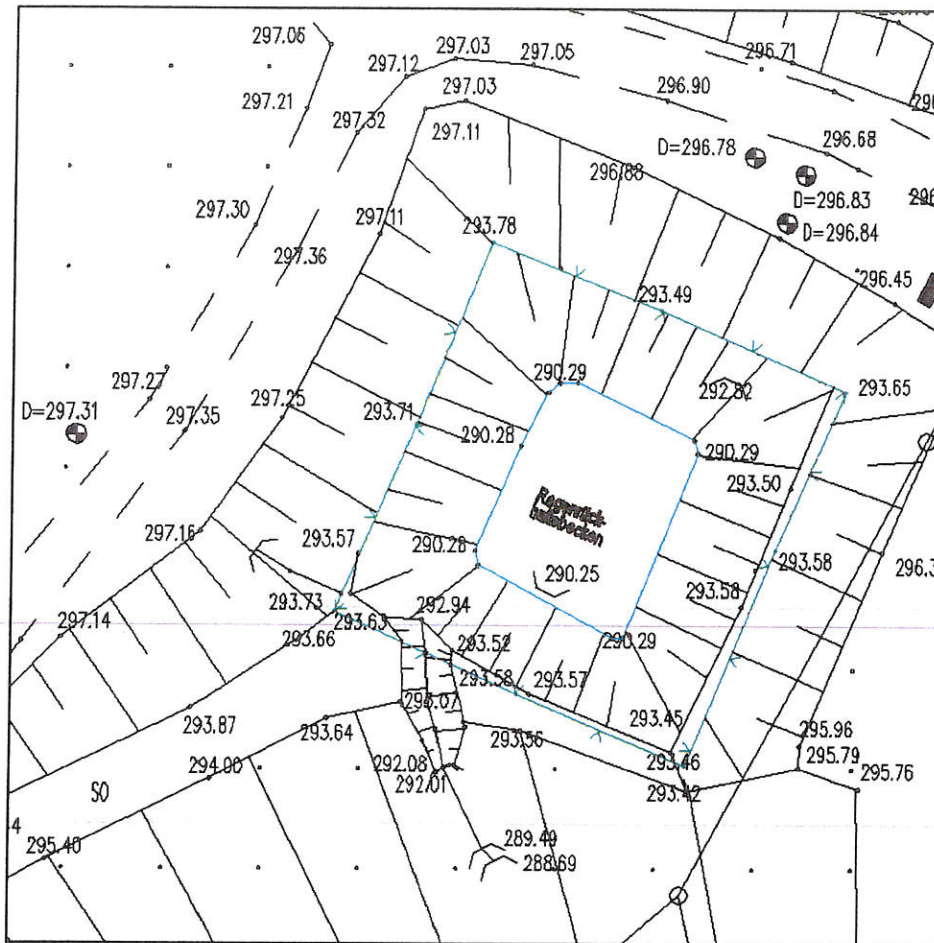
Lageplanauszug RRB – unmaßstäblich aus Vermessungsplan Fa. Becker
